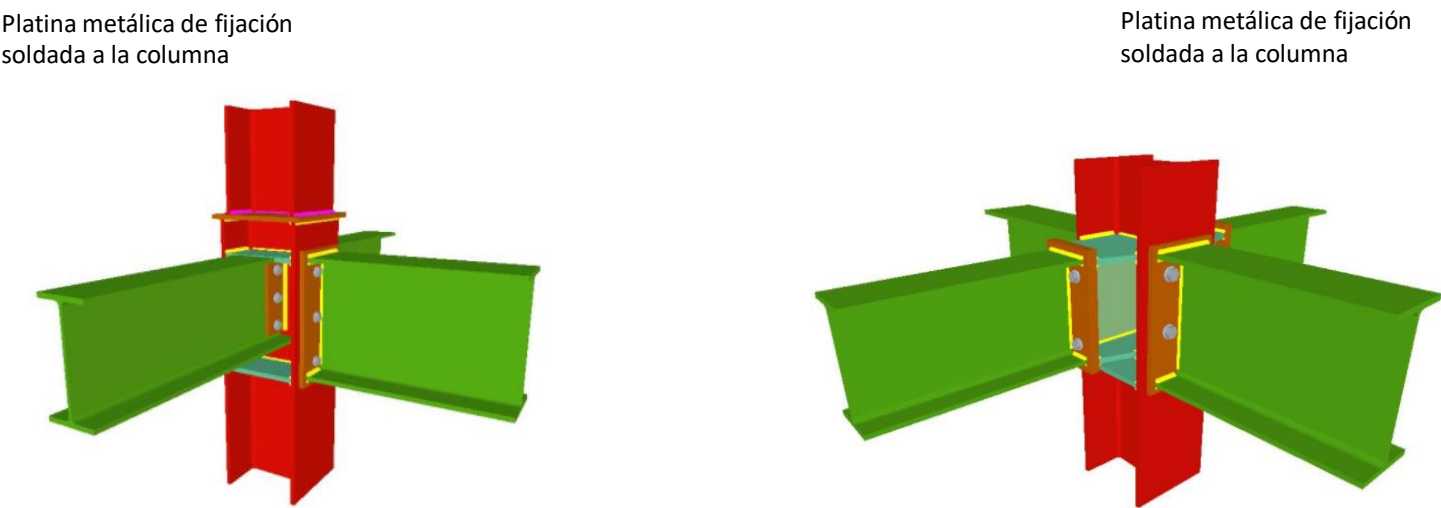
Detalle de unión de vigas y columnas. Fuente: Elaboración propia
